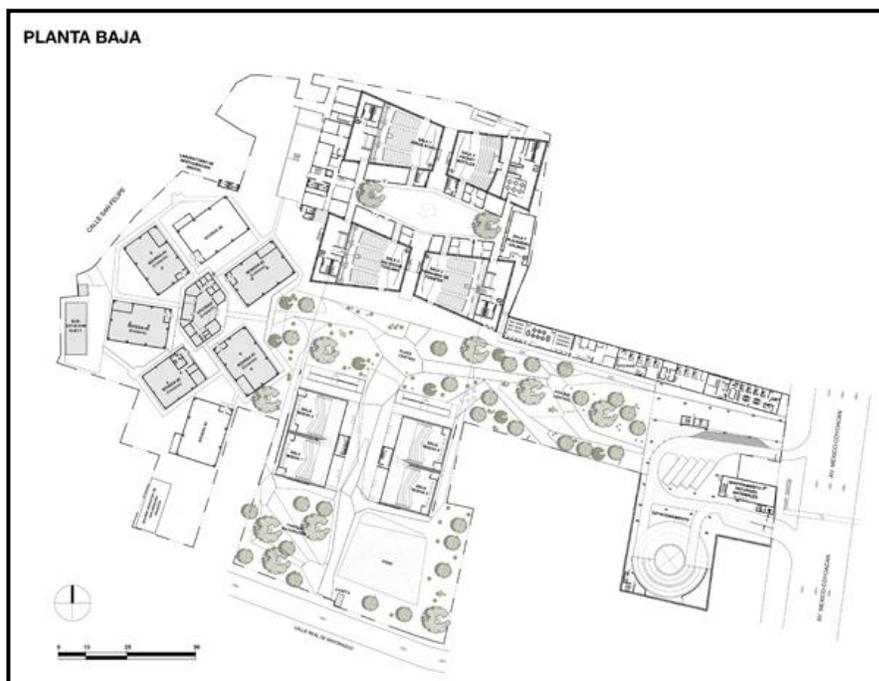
Planta baja. Fuente: <http://arquine.com/?p=7553>
